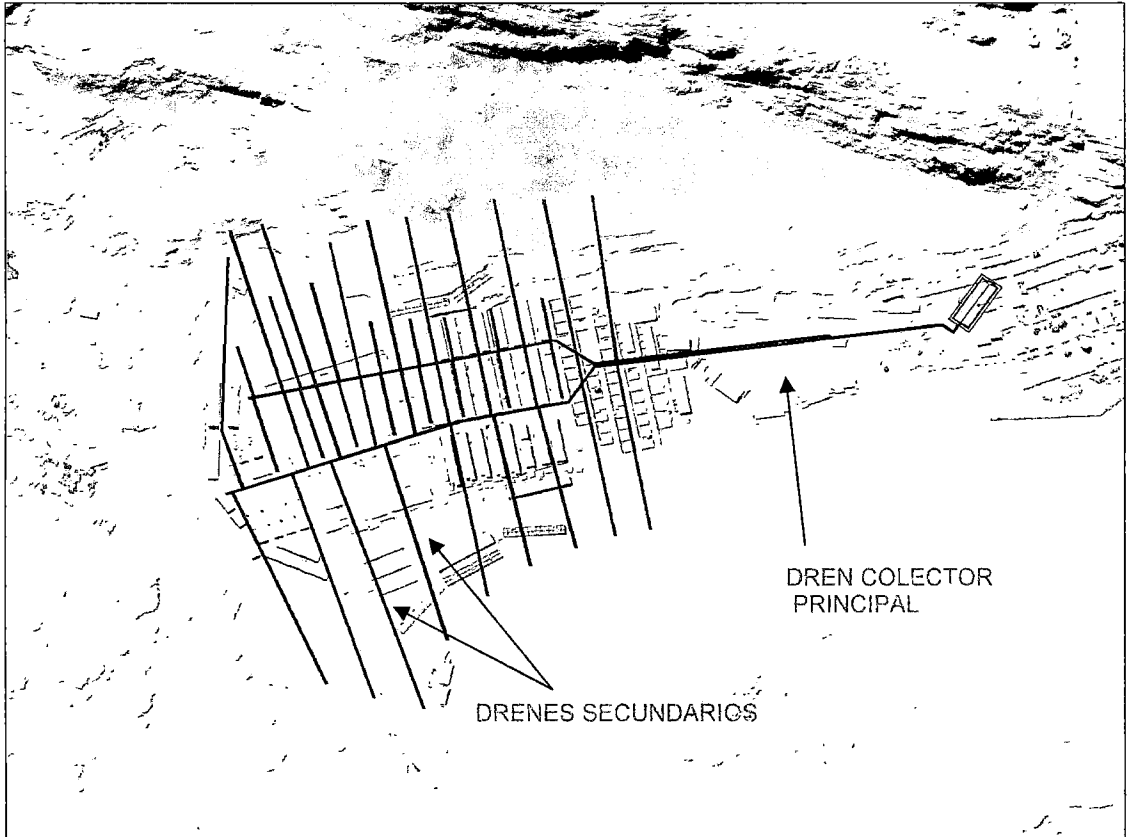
Ubicación del Sistema de Subdrenaje de aguas de infiltración
